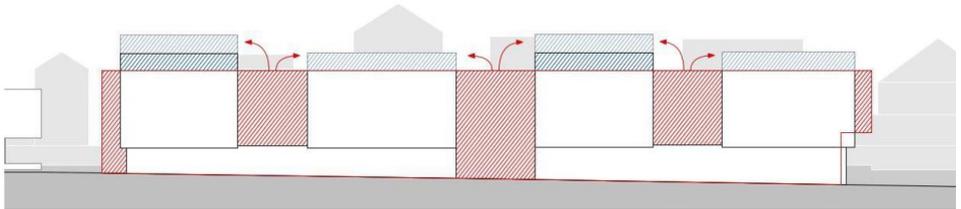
Darstellung Vergleich Richt- und Referenzprojekt – Umlagerung Baumasse, KCAP Architects&Planners, 2019
